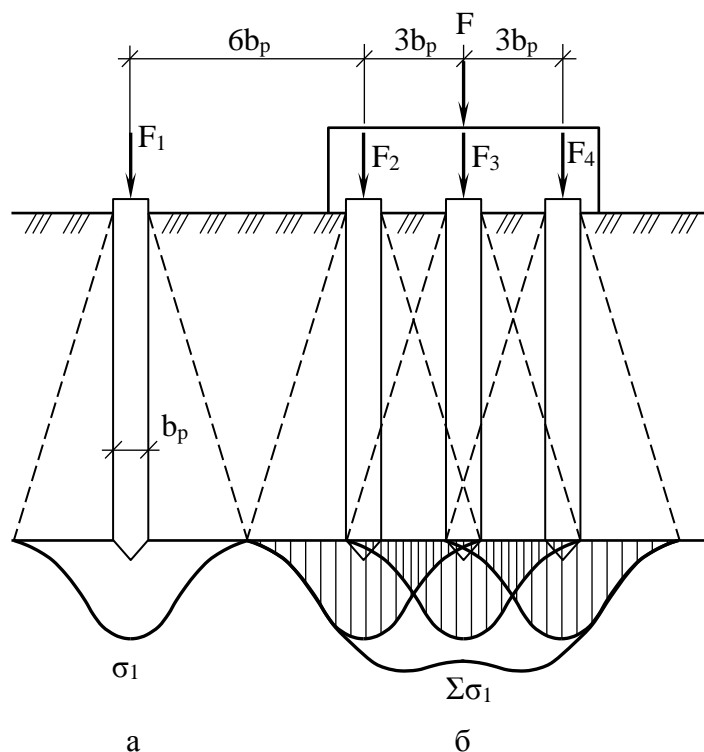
Епюри напружень в основі фундаменту: а – поодинокі палі; б – куці паль
